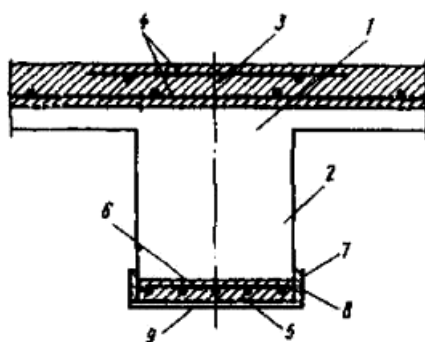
Усиление железобетонного монолитного перекрытия путём увеличения сечения существующих плит и балок
